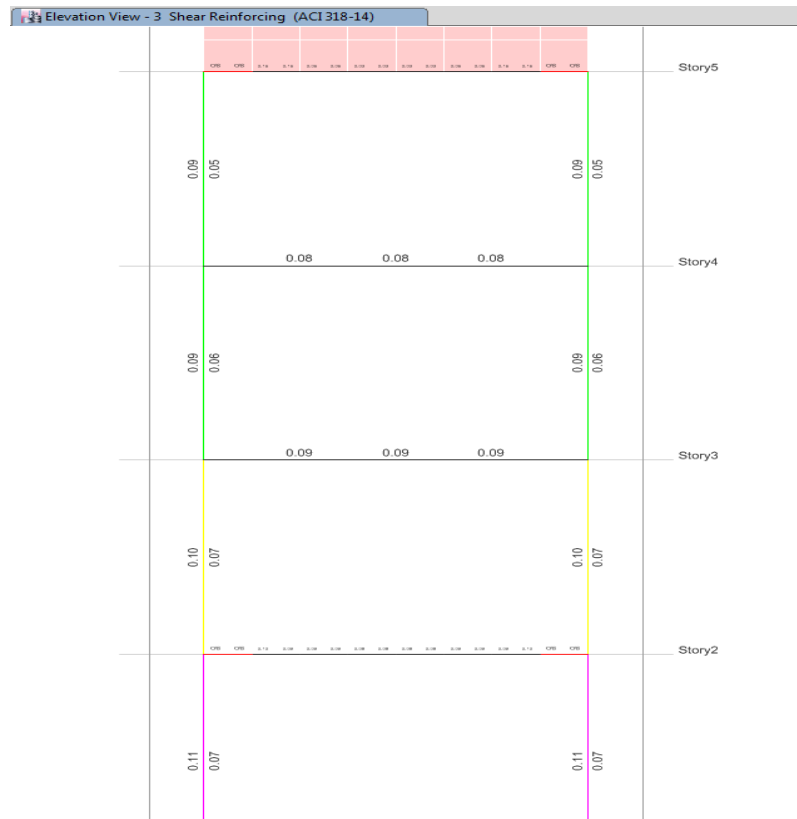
Acero por corte de viga (25X50) cisterna y tanque
